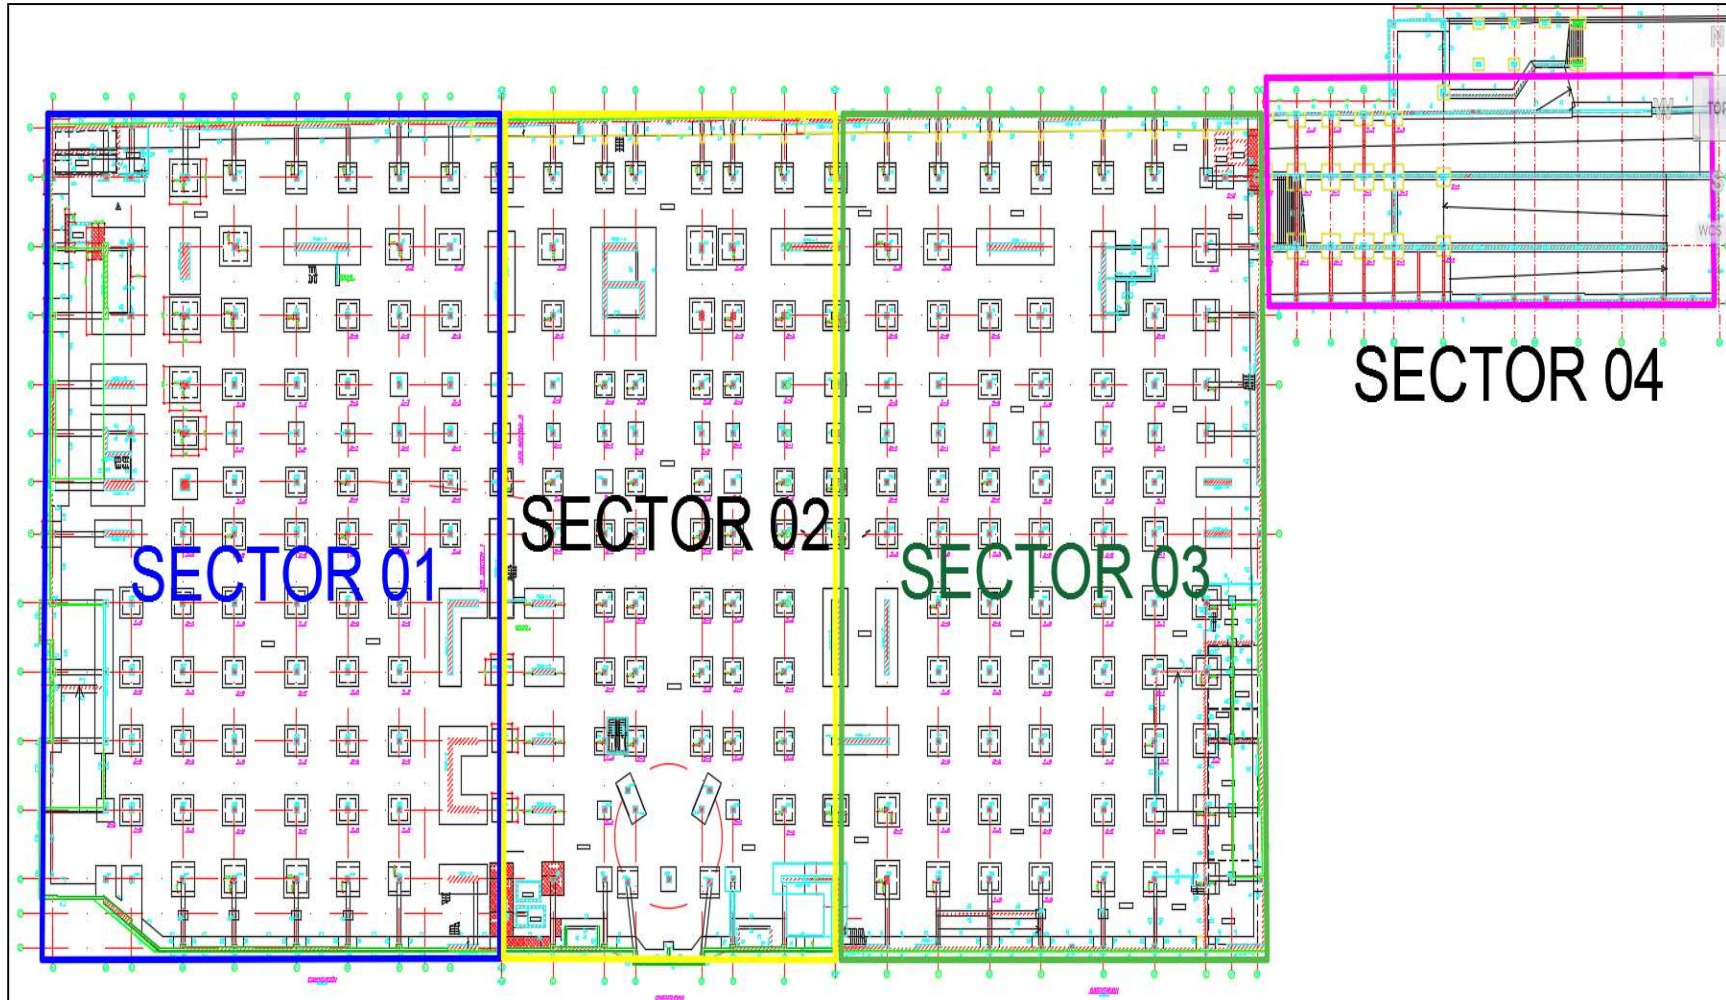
Sectorización para Ejecución de Obra – Mall Aventura Plaza “Santa Anita” - Elaboración Propia
